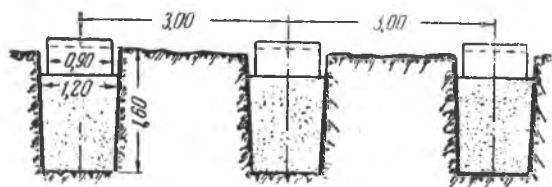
Pierwotne typy bloków prefabrykowanych na fundamenty.
